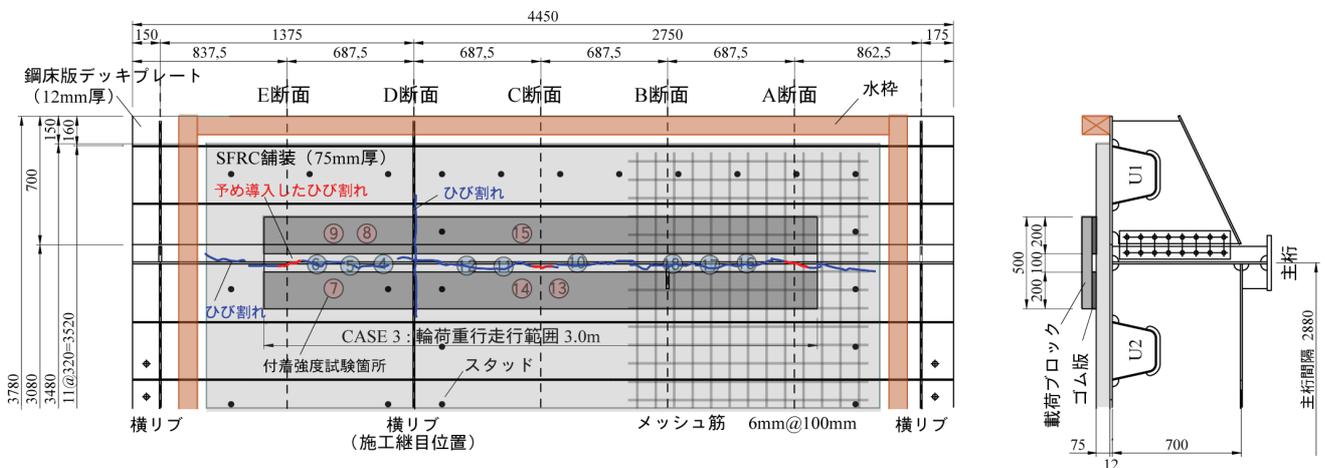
試験体および輪荷重走行後のひび割れ状況 (No.2 試験体の着目主桁部分を抜粋)
